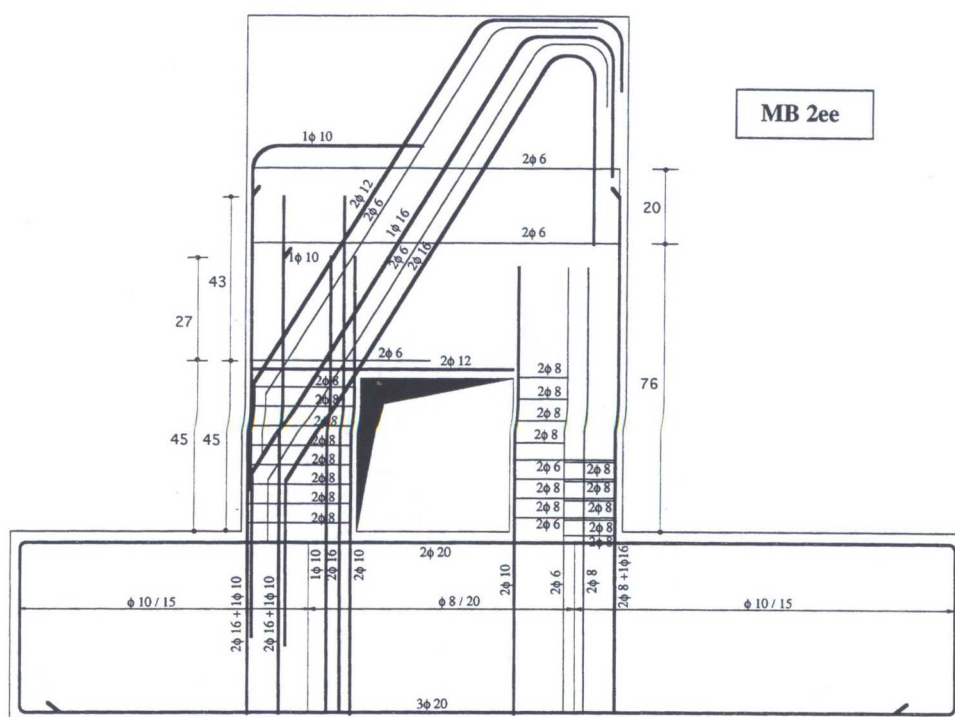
Pormenorização das armaduras do modelo MB2ee-EXP, adaptado [10]
